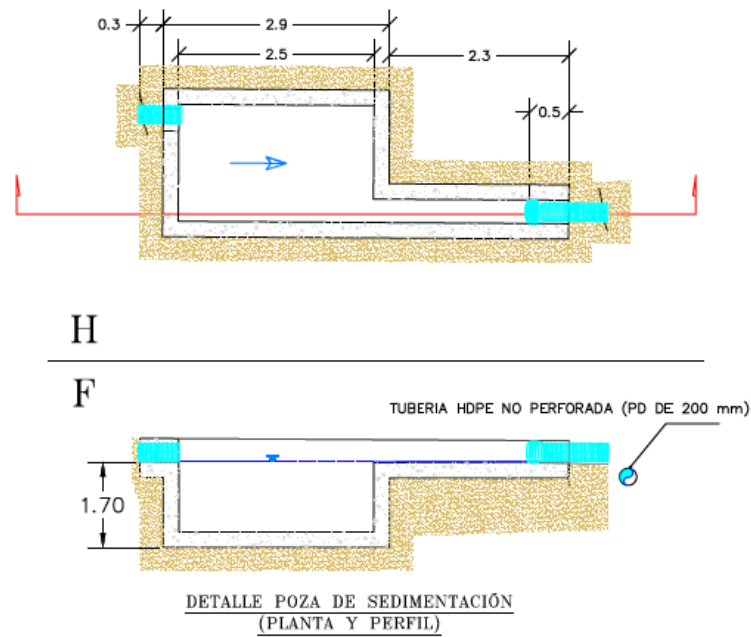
Vista en planta y perfil de la poza de sedimentación.
